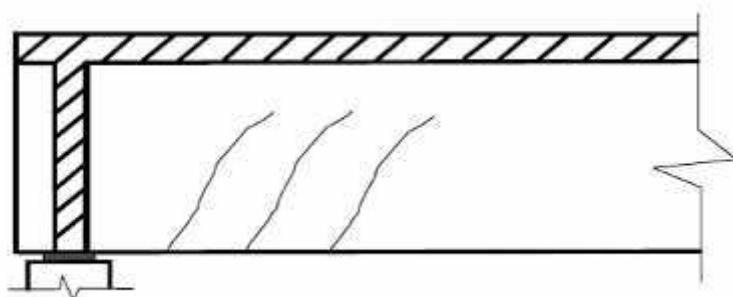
Fissuras ou rupturas por cisalhamento, fonte DNER 1994
